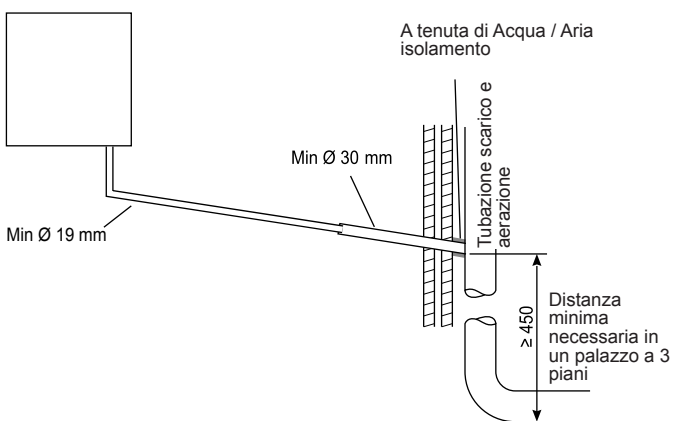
Collegamento del drenaggio della condensa al tubo di drenaggio e ventilazione
